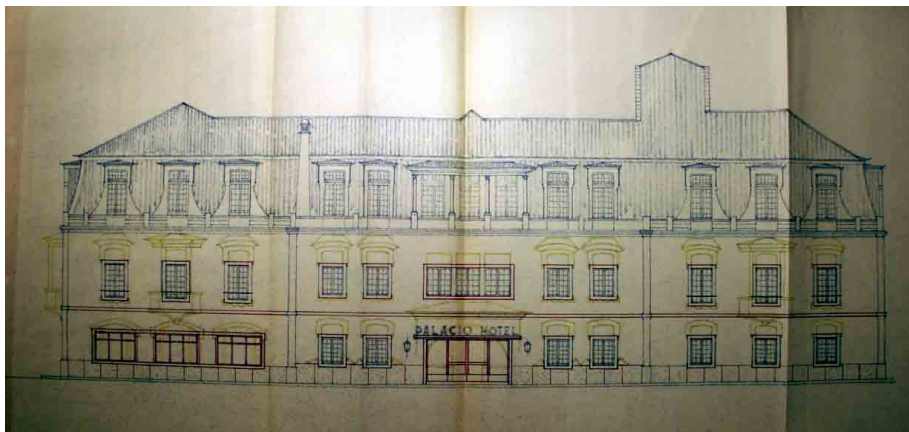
Fasada główna Palácio Hotel de Vila do Conde, 1959. Plan nakładany. Archiwum Miejskie w Vila do Conde.
